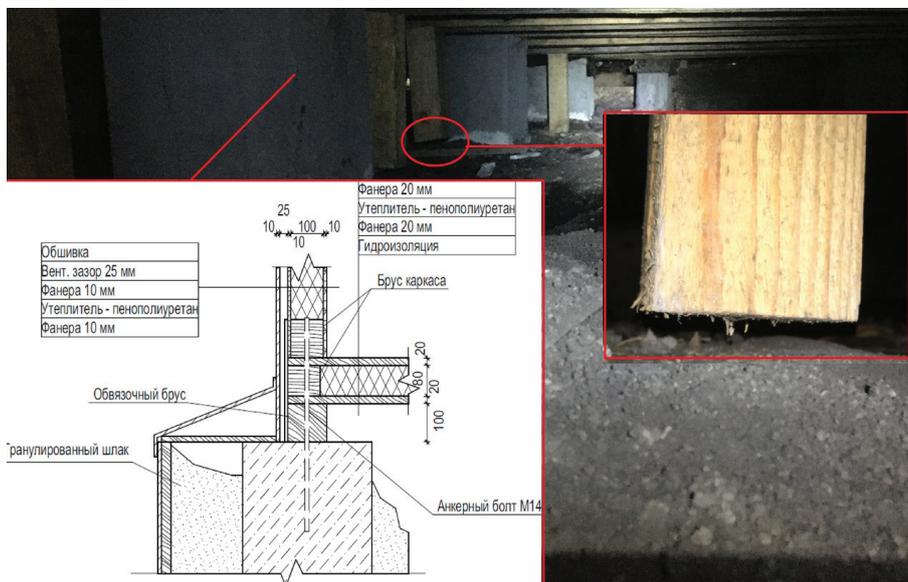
Общий вид подполья и поперечный разрез фундамента
